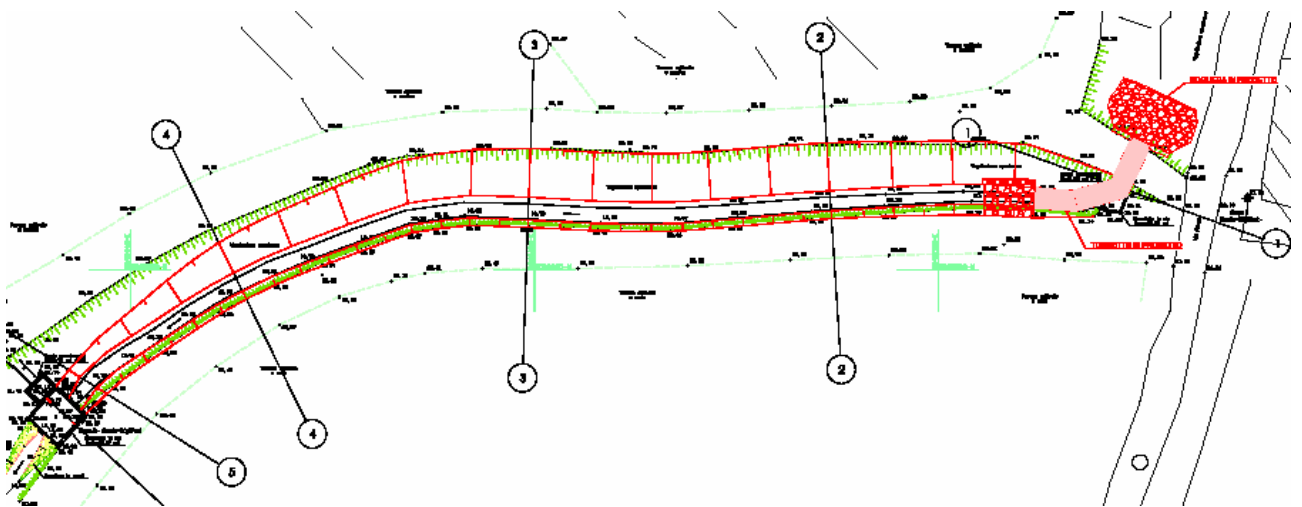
Planimetria di progetto della sistemazione del fossato (intervento b).
